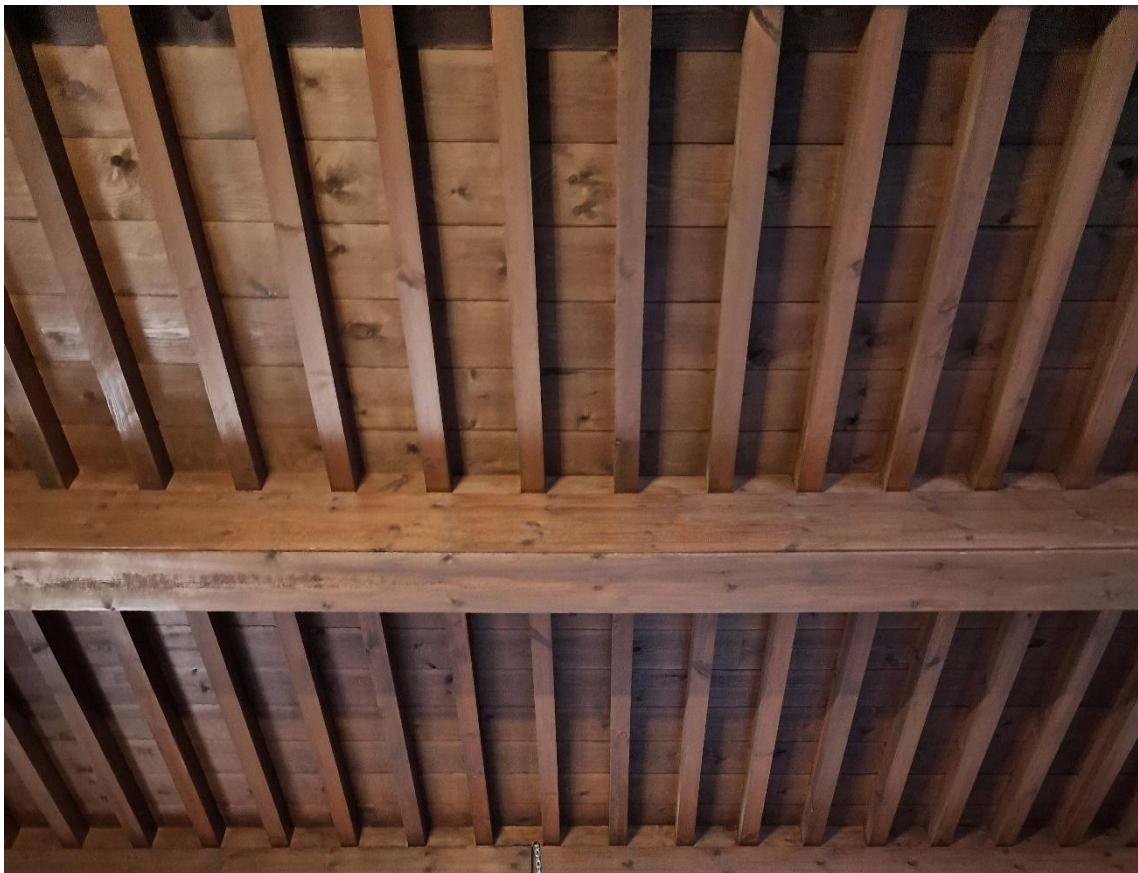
y 4.21: dos techos planos lignarios simples, con un solo orden de vigas (las jácenas, que dan apoyo a las tablazones), separados en dos secciones por una viga maestra. Los estribos descansan en canecillos dobles apoyados en columnas. Claustro Superior del Convento de *Las Puras* (Almería). Capturas del 27 de noviembre de 2023.
